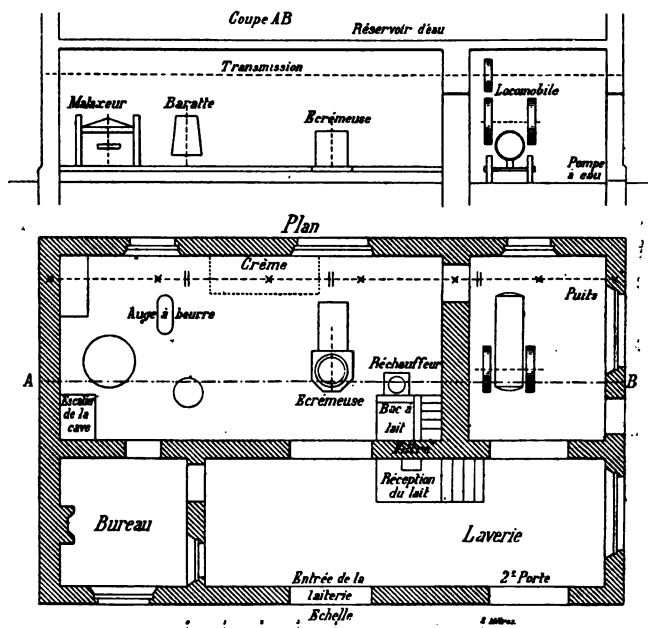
PLAN D'UNE PETITE LAITERIE.
